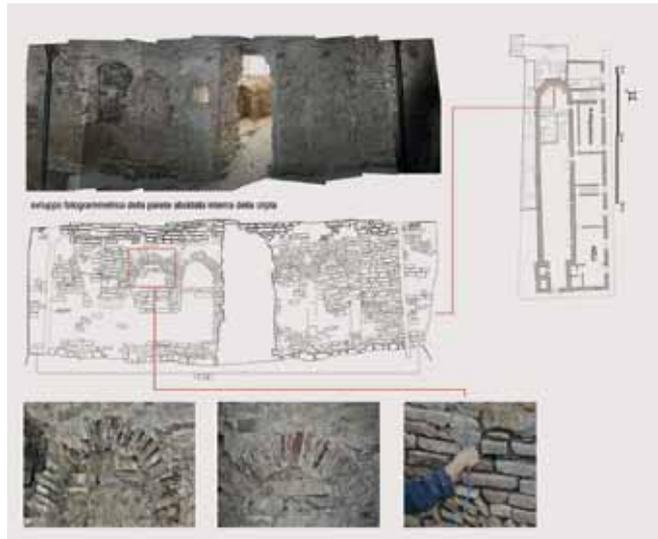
Foto e prospetto delle murature antiche - Pianta della struttura - Intervento di restauro
